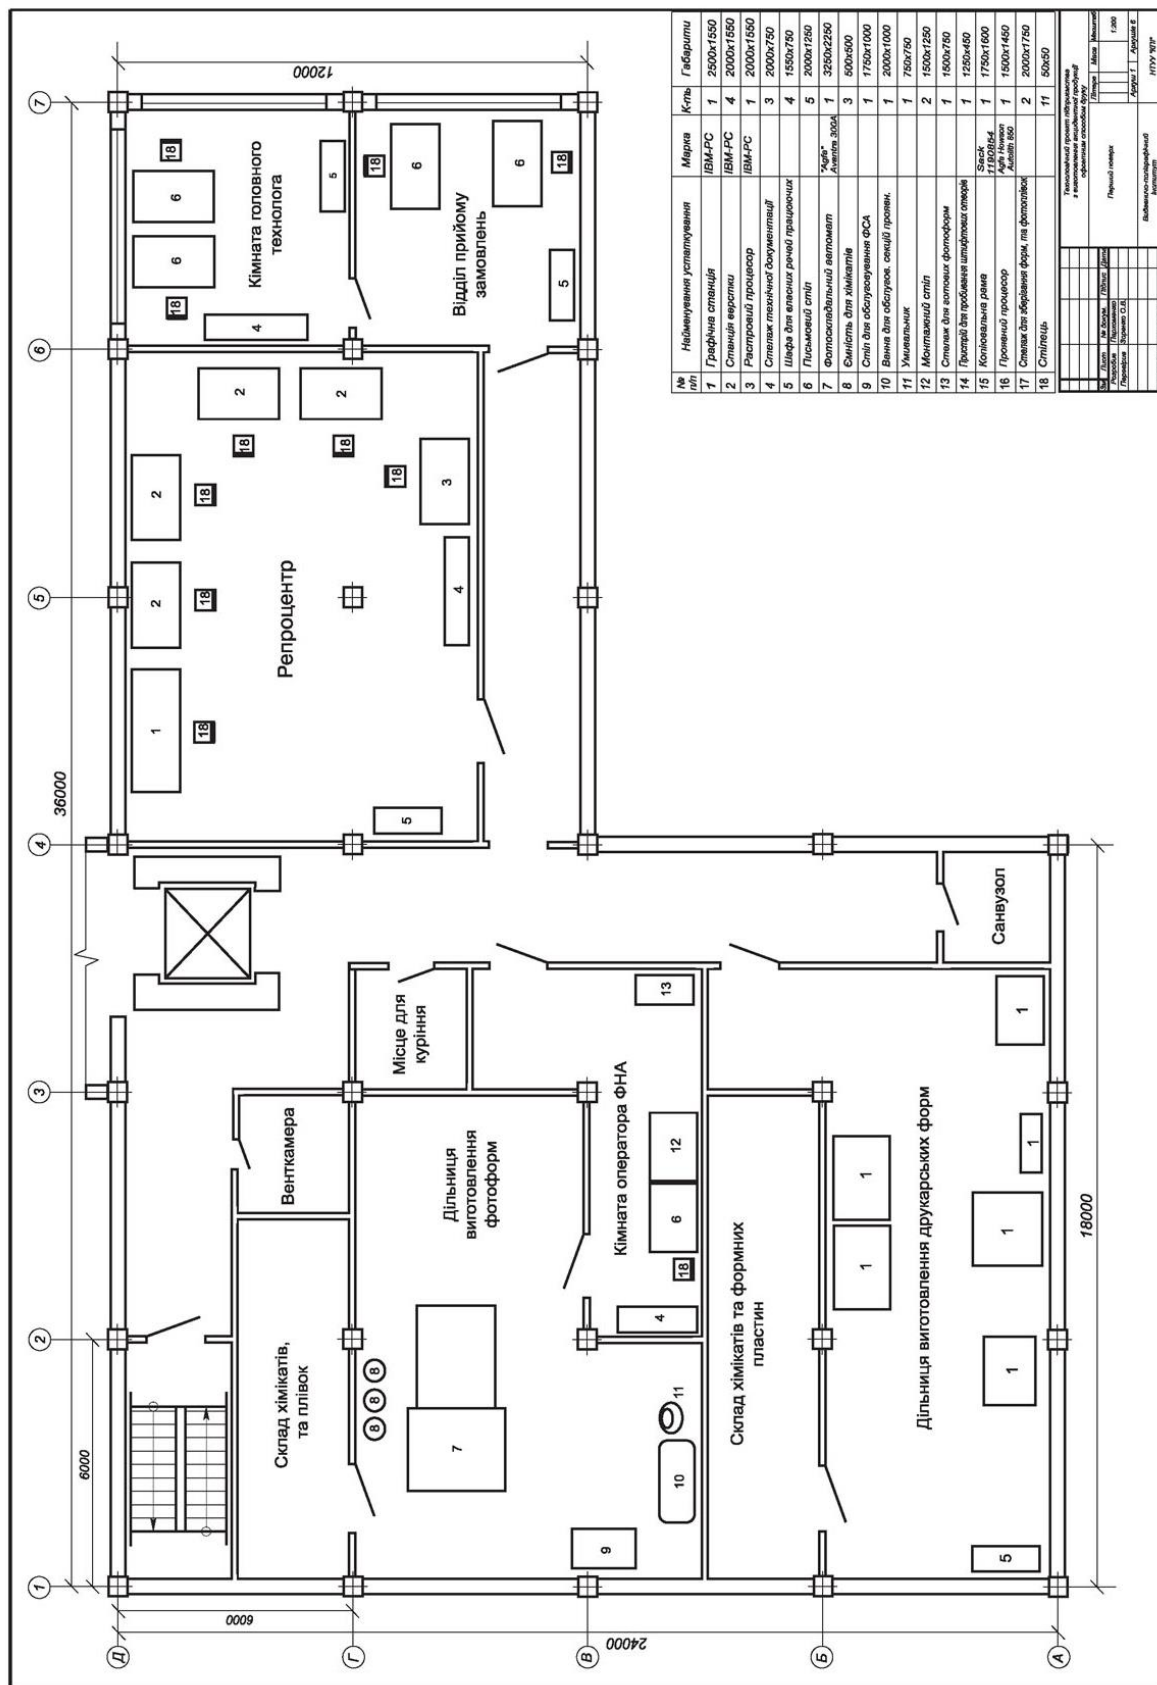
Приклад оформлення плану приміщень першого поверху друкарні
